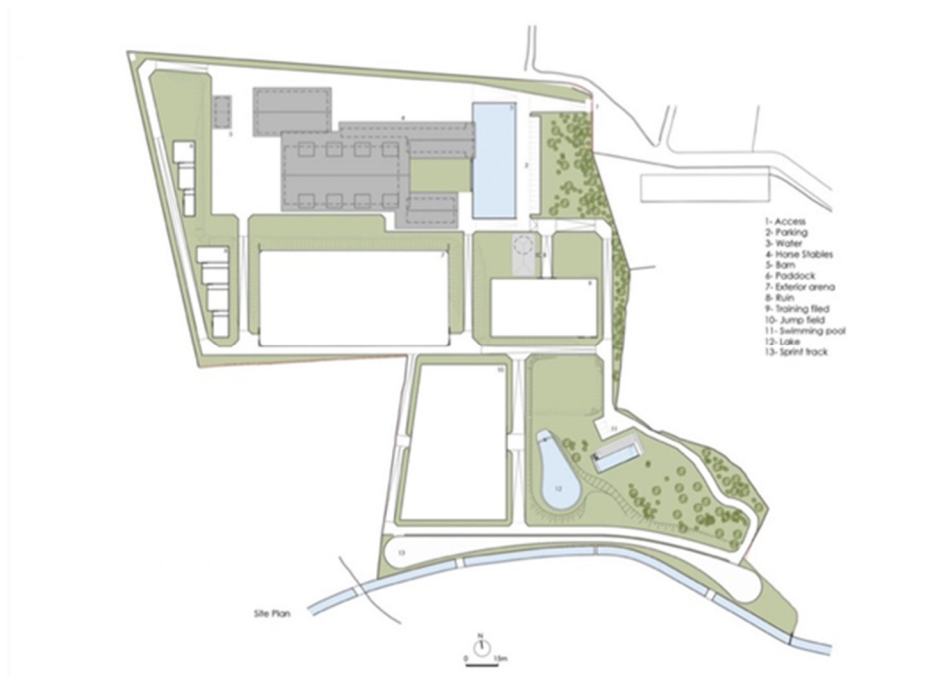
8 - Planta de coberturas do Centro Equestre.
